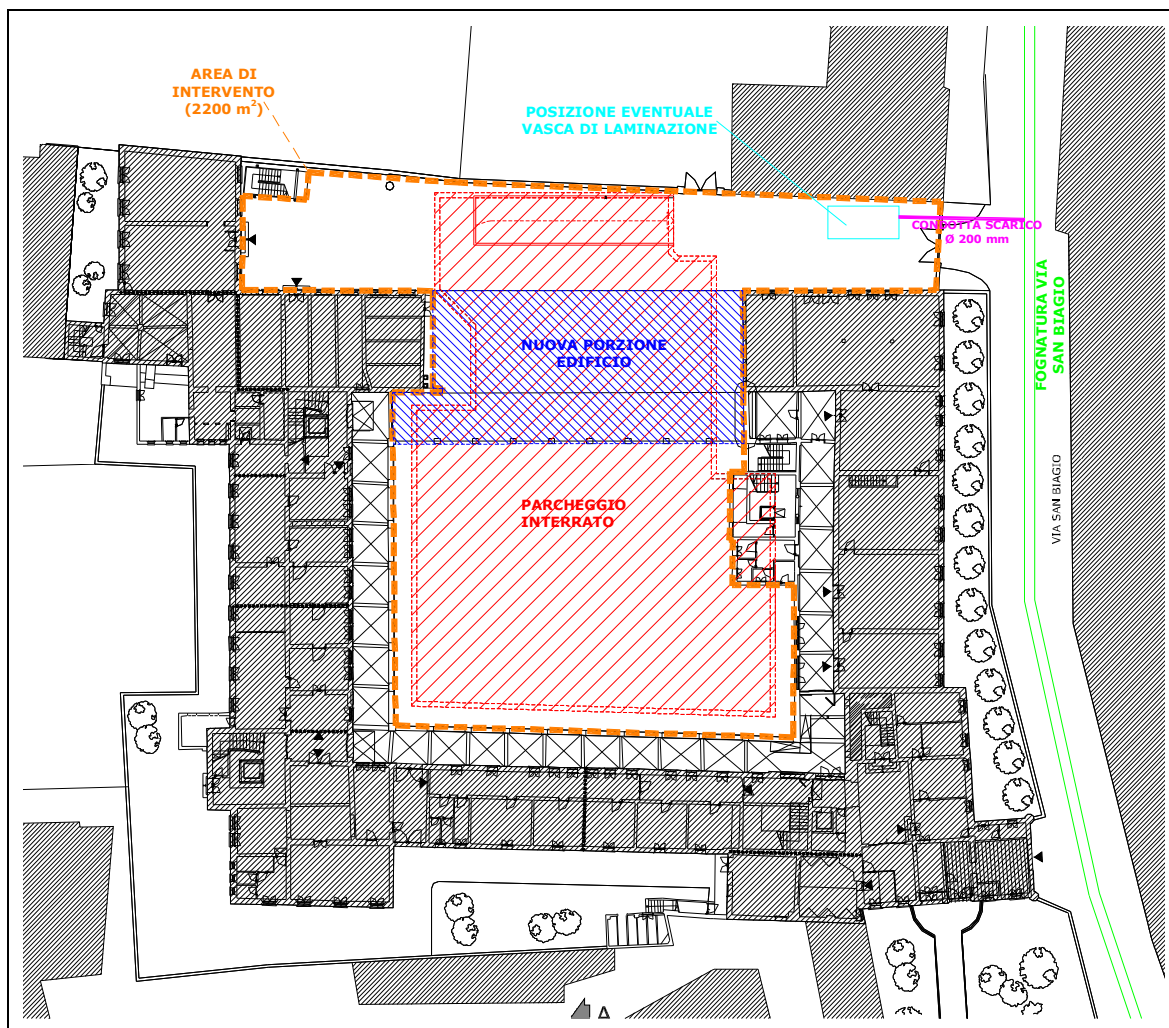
Planimetria dell'area e indicazioni dei principali interventi previsti nel progetto di recupero
